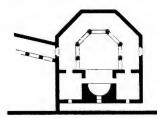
Baptifterium in Mudscheleha. Grundriss.
